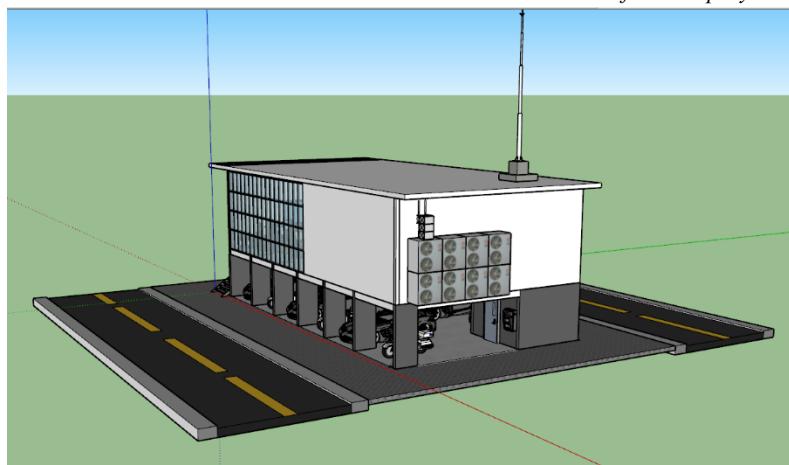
Segunda vista exterior del edificio del proyecto.
